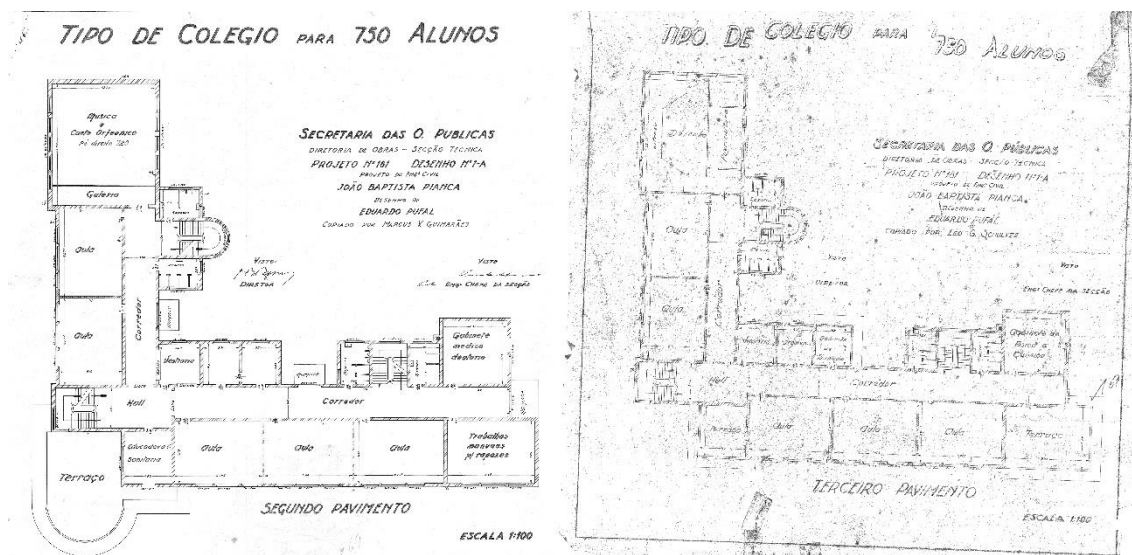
Planta de 2º e 3º pavimentos de Tipo de Colégio para 750 alunos.
